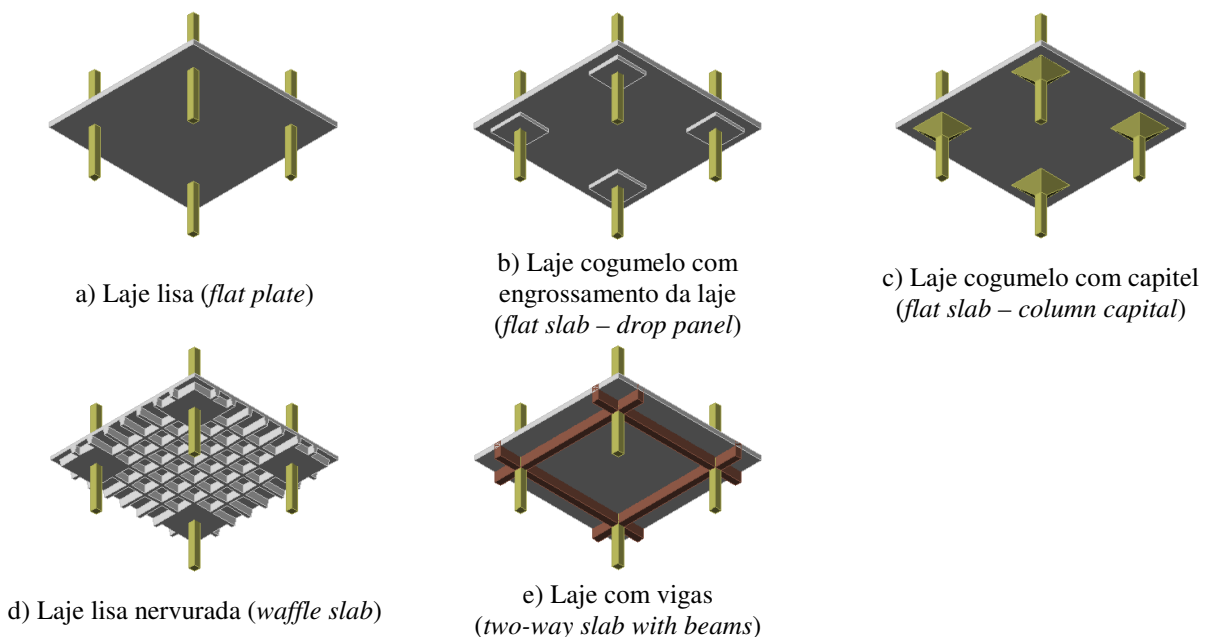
Exemplos de sistemas estruturais para as lajes em concreto armado
